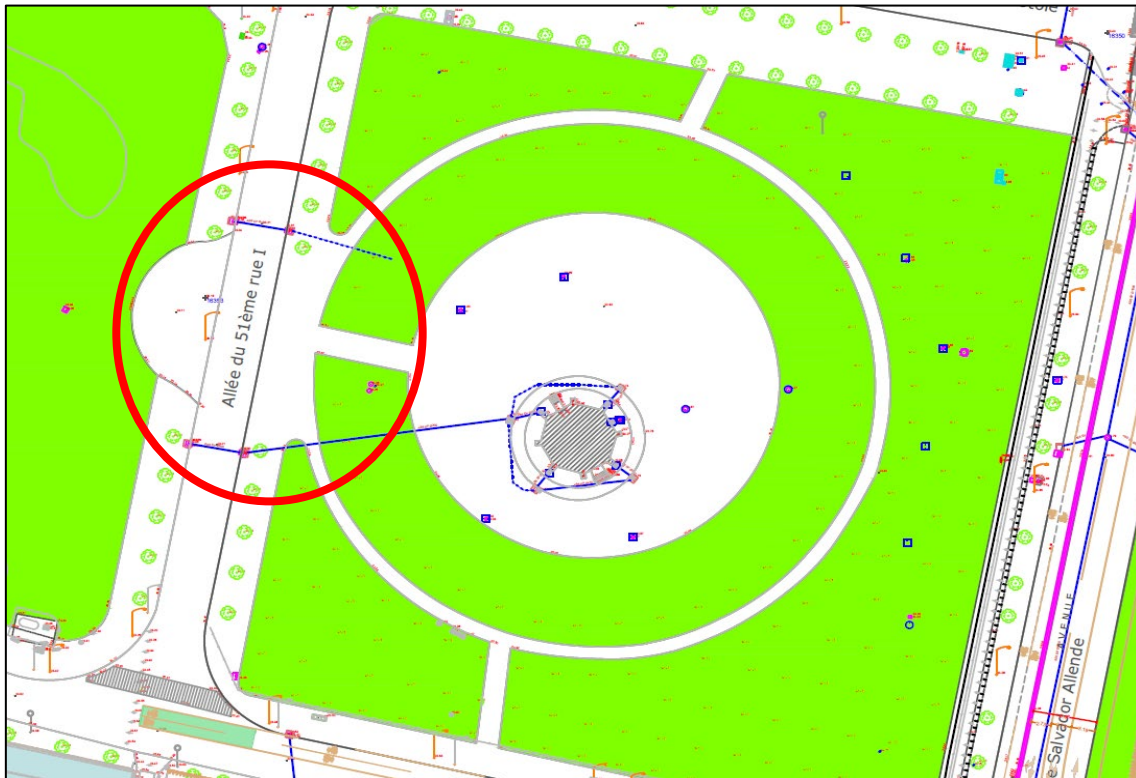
Extrait de plan du réseau pluvial - secteur est
